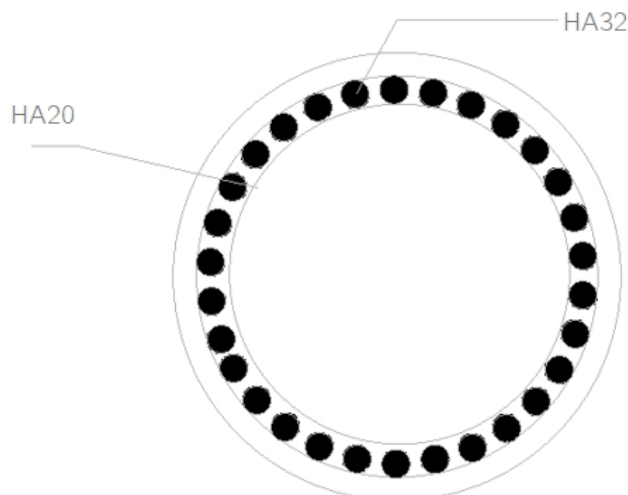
Schéma de ferrailage du pieu de la culée
